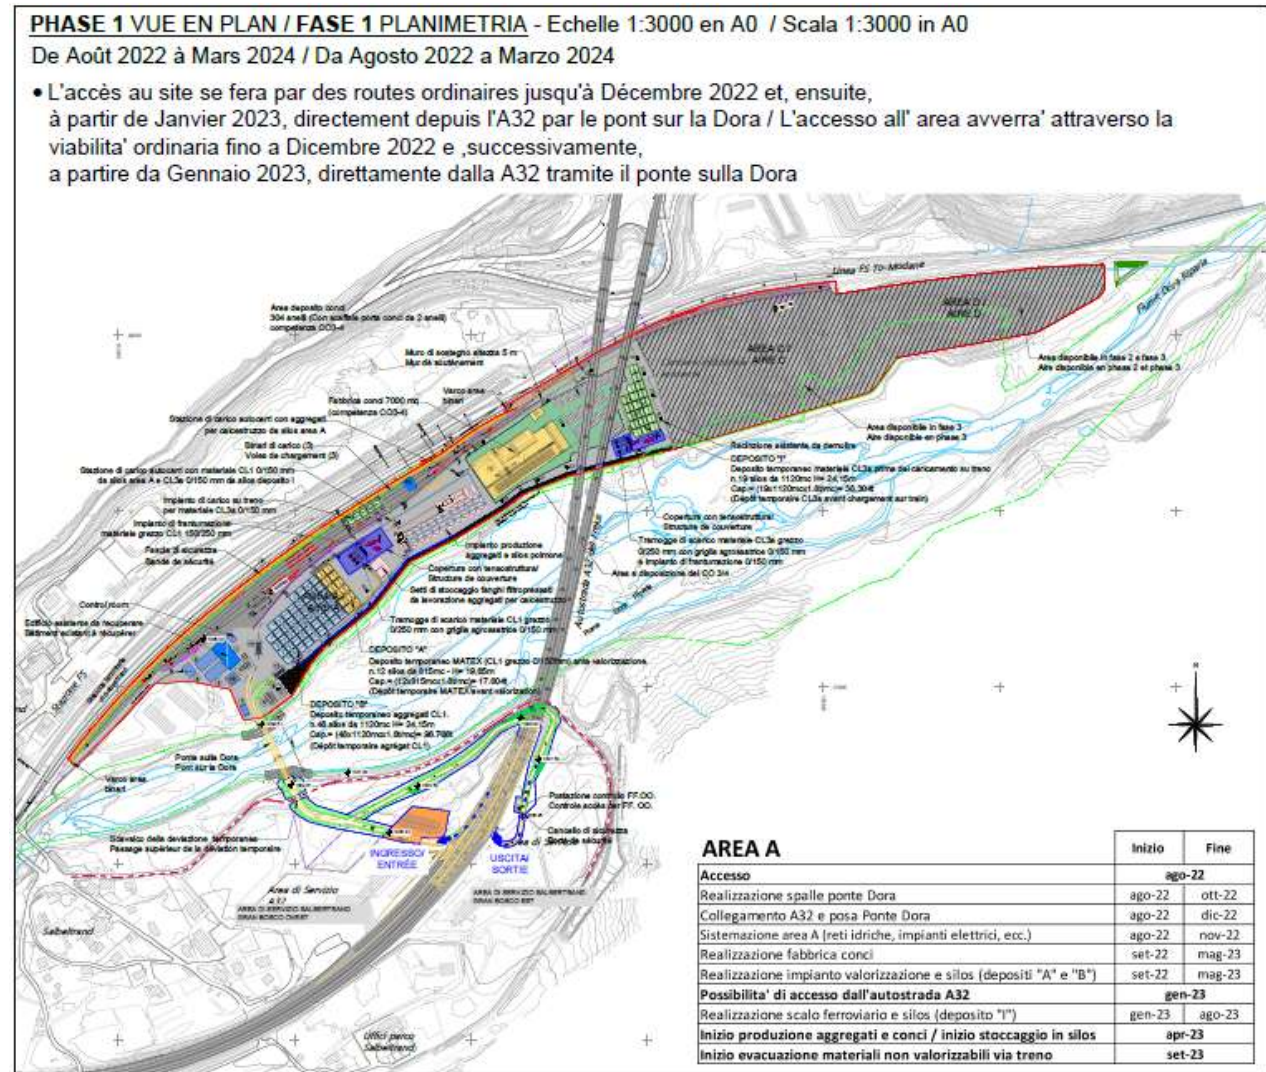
Area di occupazione del Cantiere industriale di Salbertrand – Fase 1
